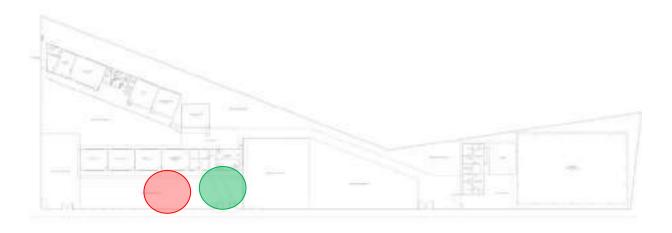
Planta baixa da EMEF Sen. Alberto Pasqualini, ponto de encontro.
